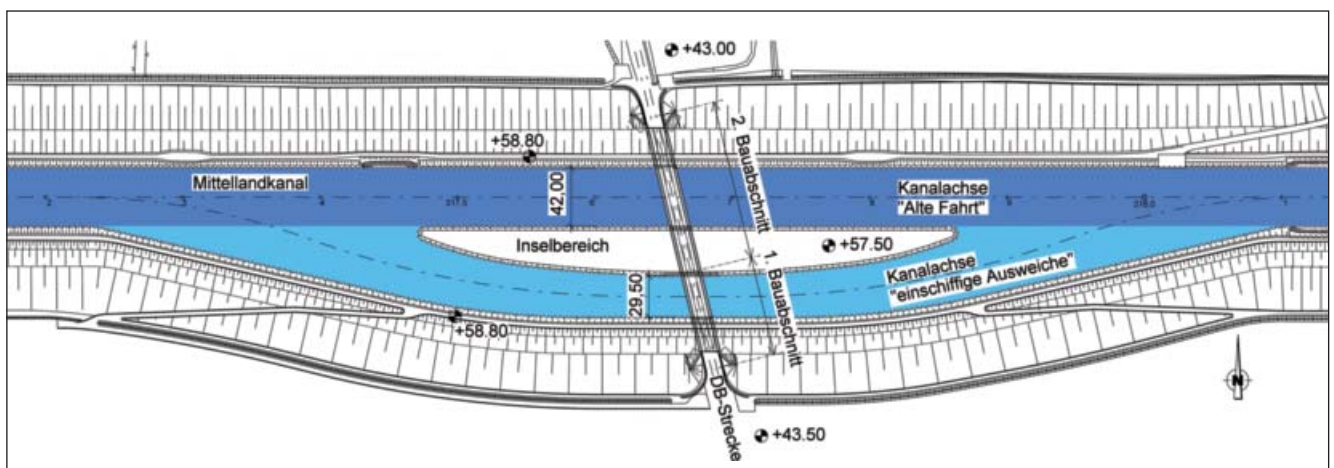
Lageplan: Neubau als Brücke in Standardbreite in Alter Fahrt mit einschiffiger Ausweiche in Neuer Fahrt
